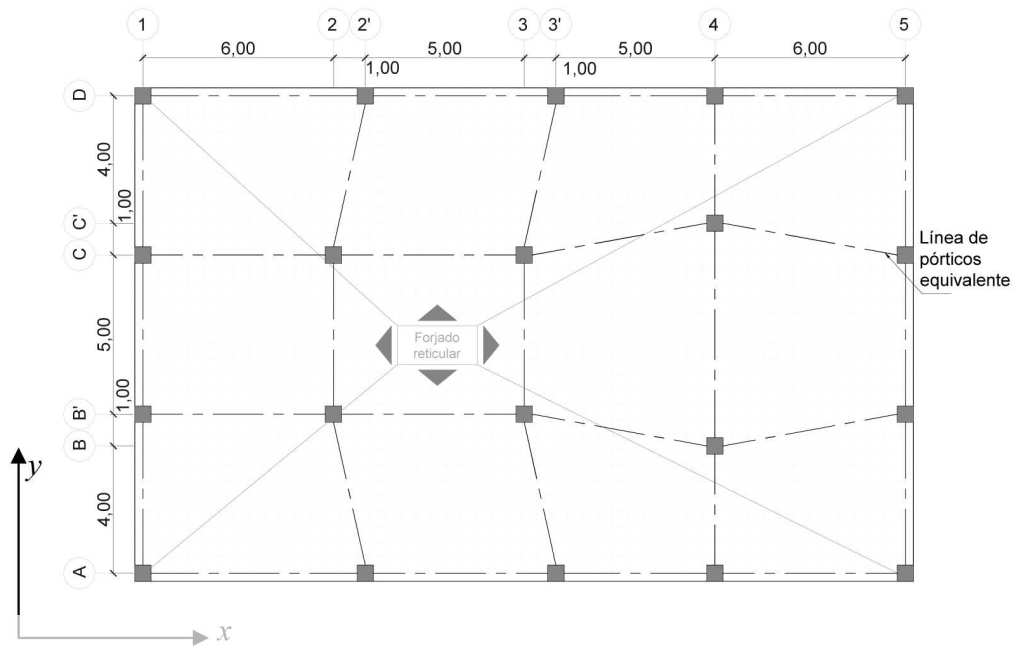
Planta típica del edificio con forjados reticulares (igual en todos los niveles).
